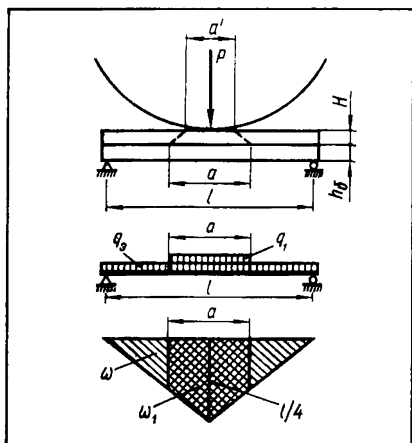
Схема к определению эквивалентной нагрузки от Н-30 и НК-80 для мостов с пролетами менее 2 м.
